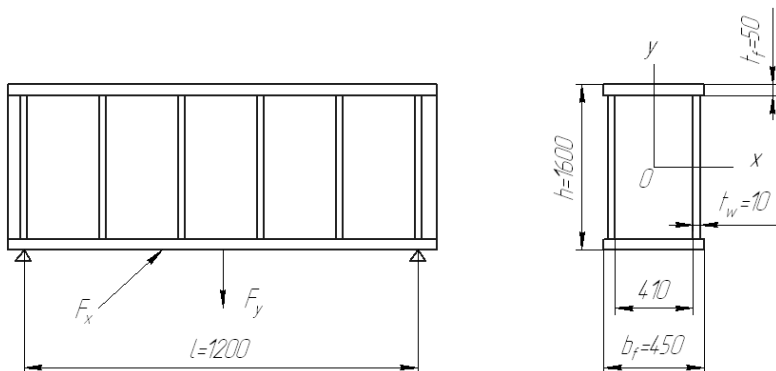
Схема коробчатой балки и ее поперечного сечения
